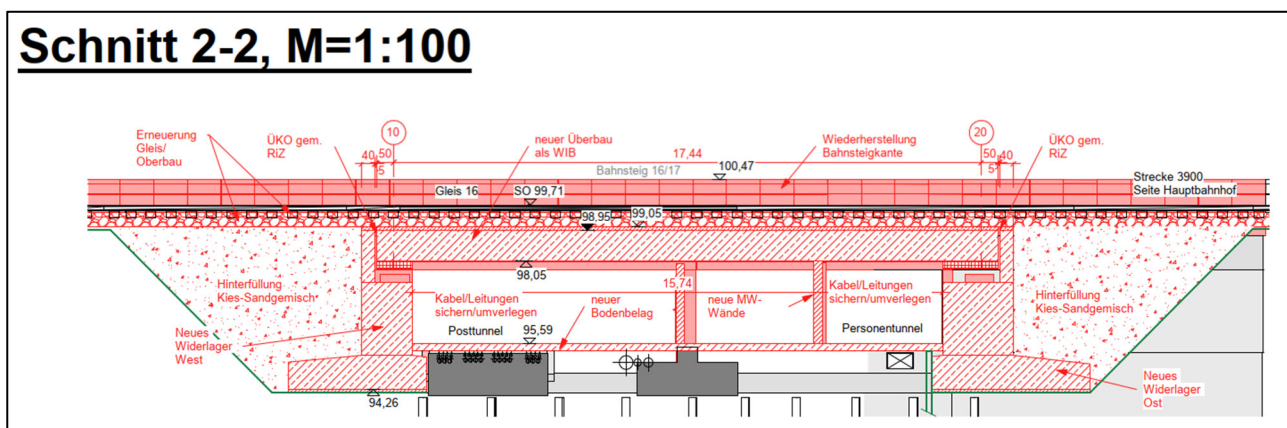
Schnitt durch den geplanten Neubau [U2]
